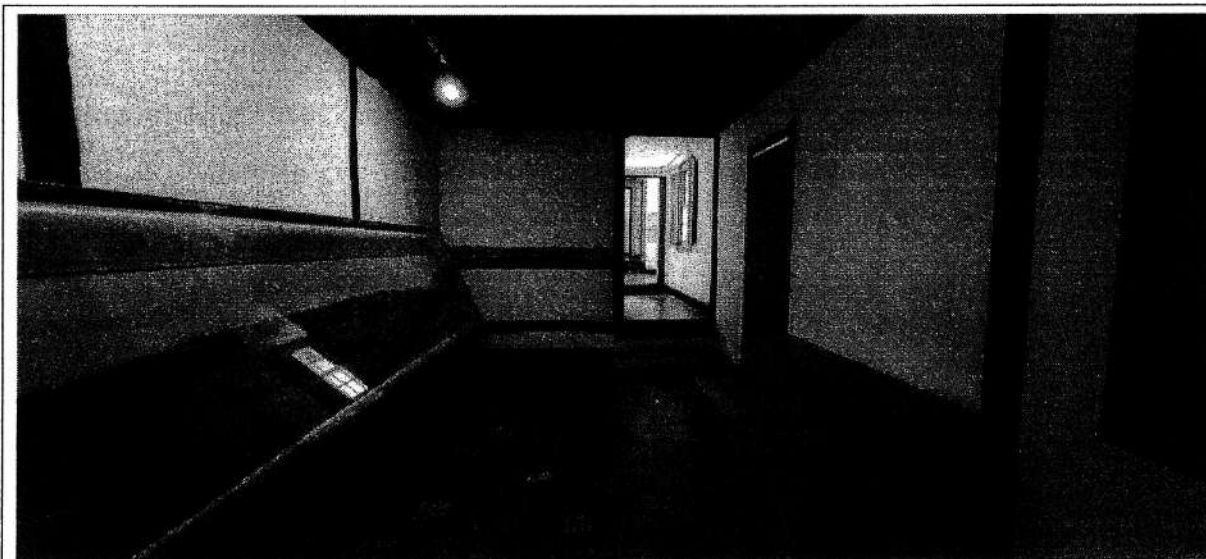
Casarão – 1º pavimento – possui desníveis internos
